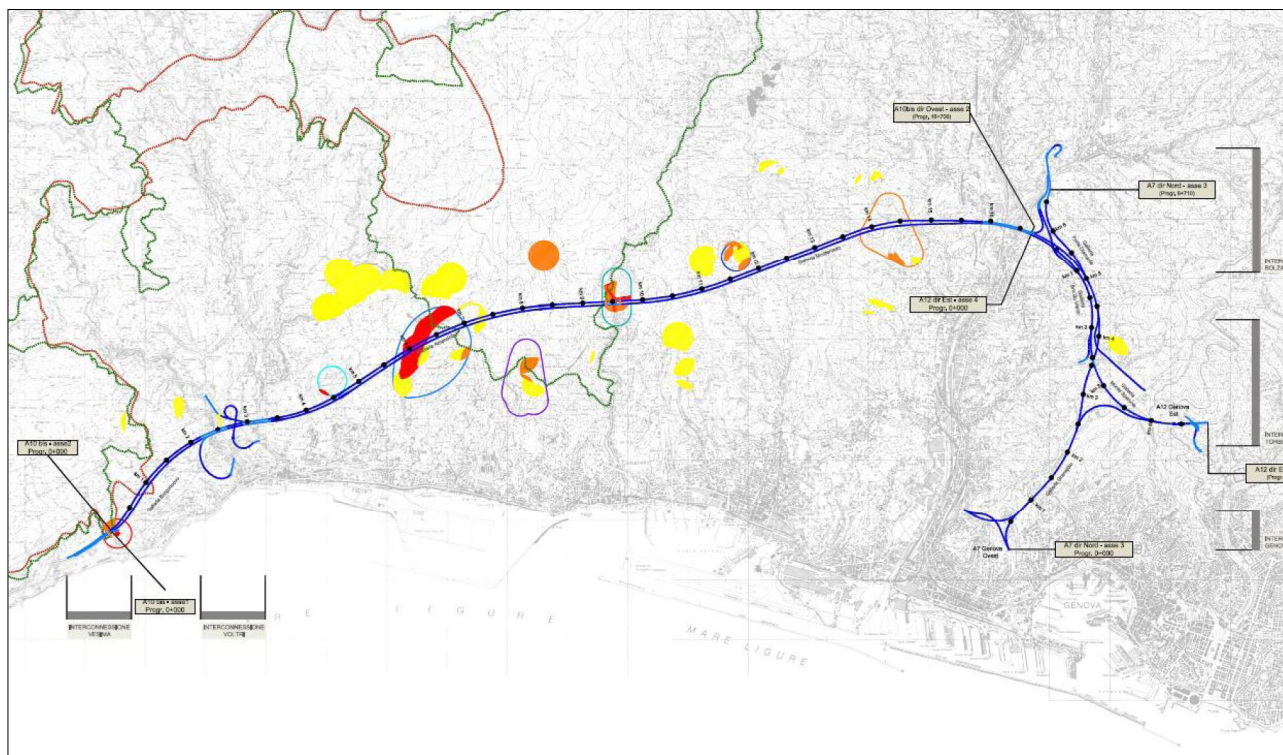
Stralcio dalla tavola planimetrica con l'ubicazione dei 7 ambiti di interesse
